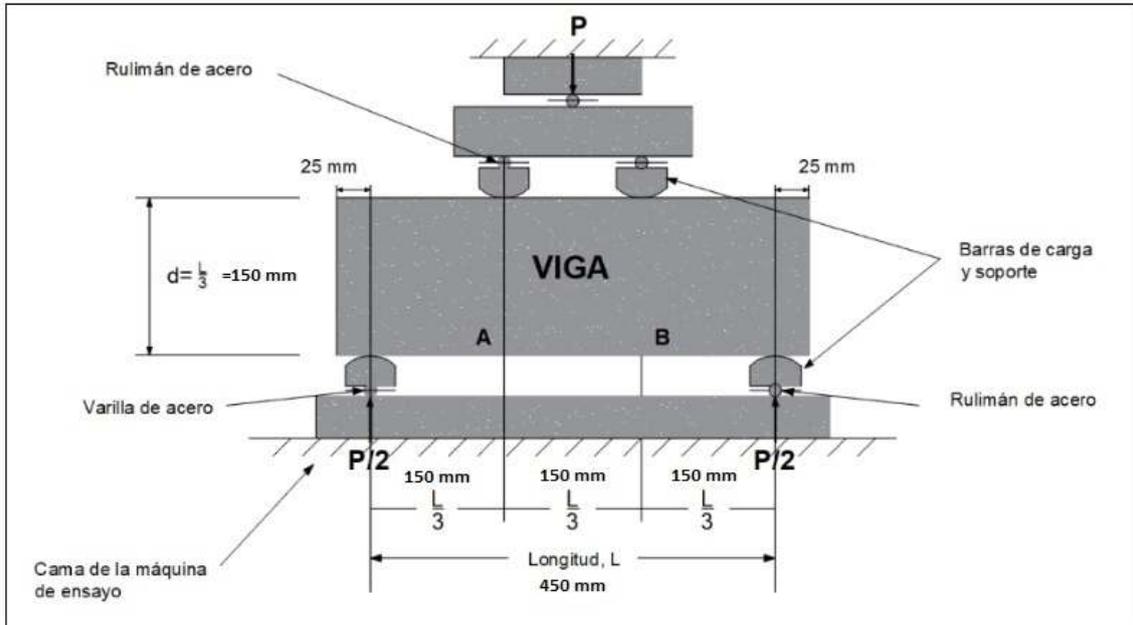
Flexión de las Vigas de Concreto (Fuente: Equipos para ensayos de materiales | Matest. (s. f.). <https://www.matest.com/es>)
